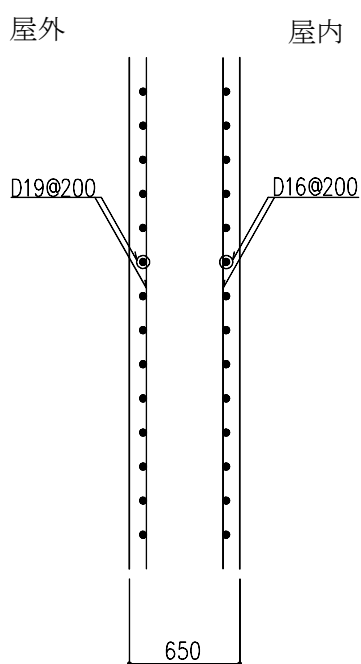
耐震壁の配筋図 (地下1階, YH通り X17~X18通り間) (単位: mm)
